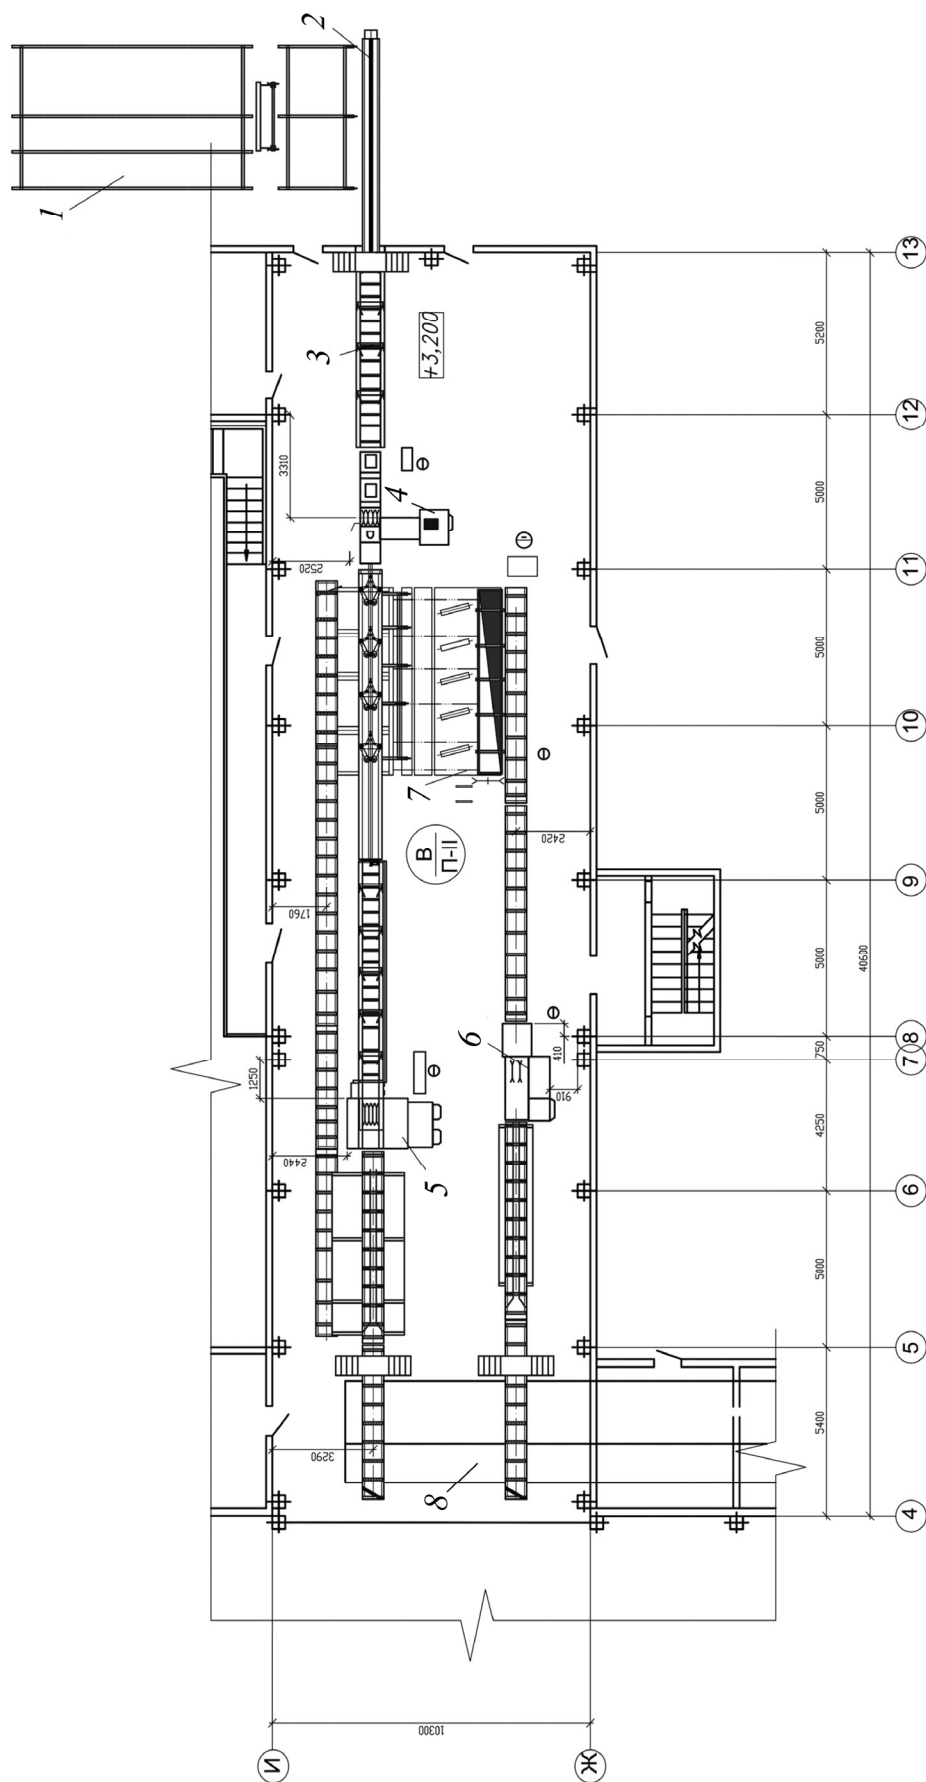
Схема лесопильного цеха на базе круглопильных станков:
